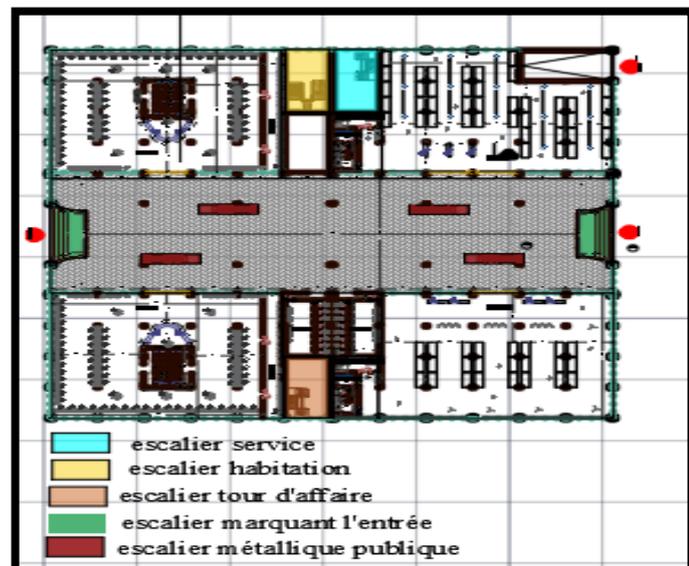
schéma de circulation vertical en plan (source : auteur).
